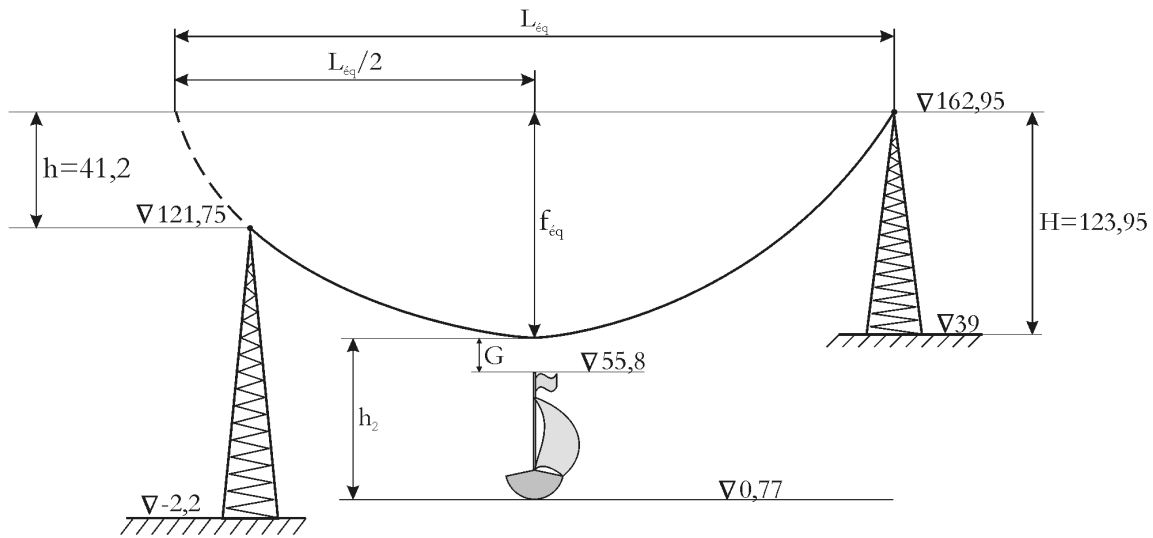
К расчету габарита провода на переходе ВЛ
